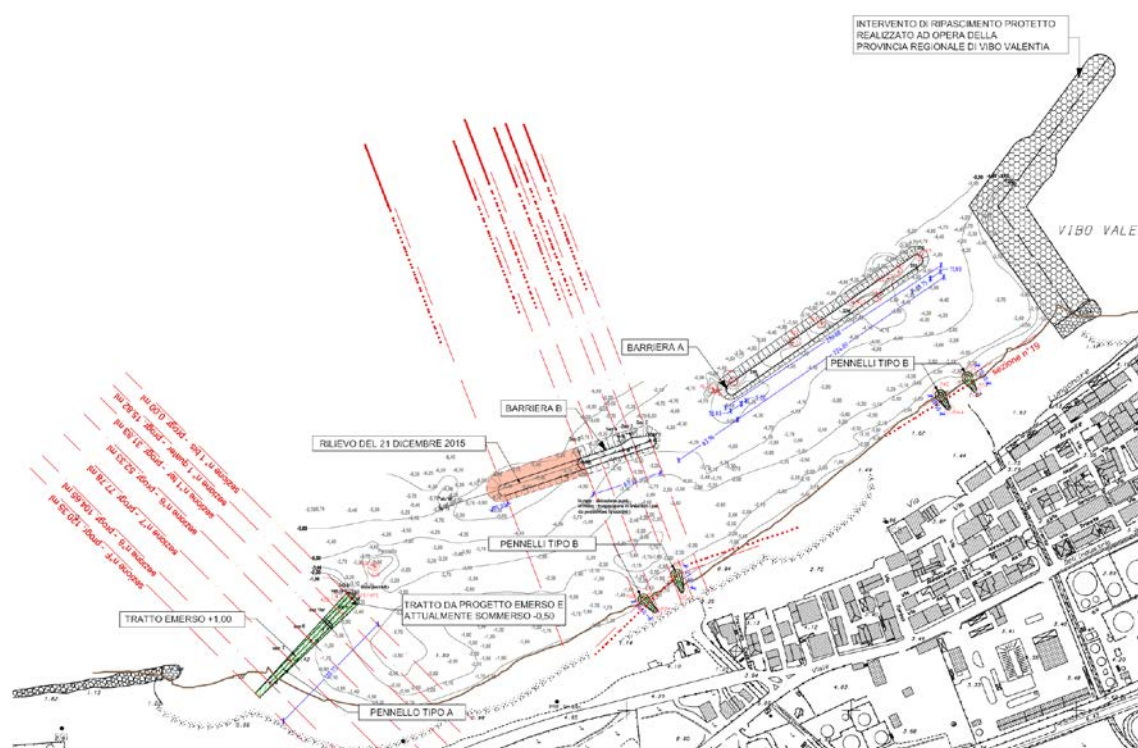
Planimetria delle opere realizzate al primo stato di consistenza – 24.06.2014
